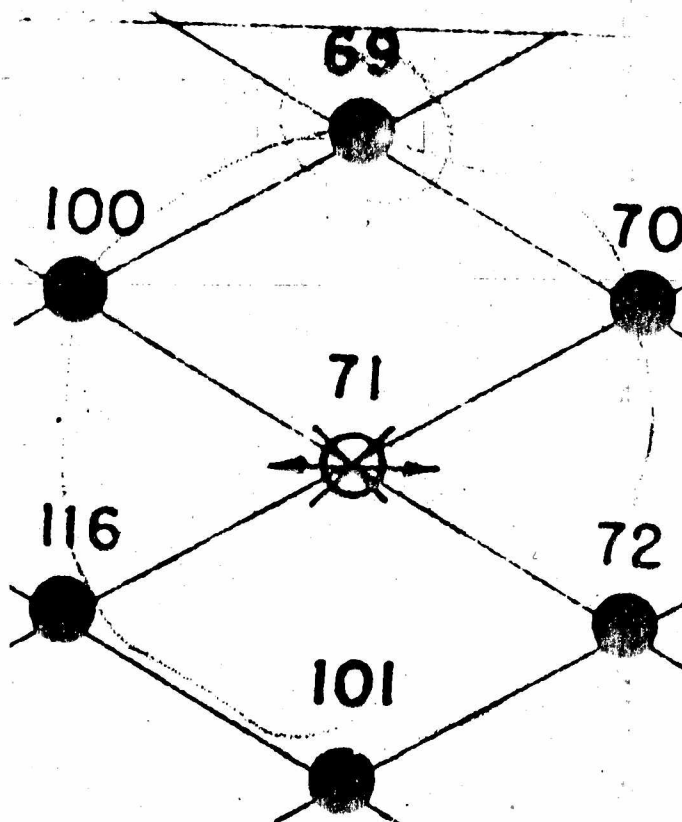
Detalle en planta de la zona involucrada por la primera experiencia.
